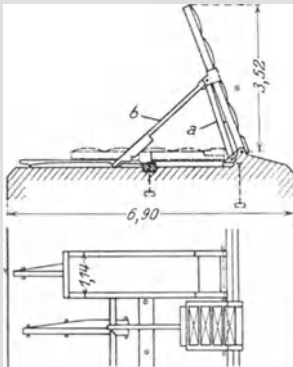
a u. b. Klappe mit ausrückbarer Stütze. Maßstab 1 : 130.
